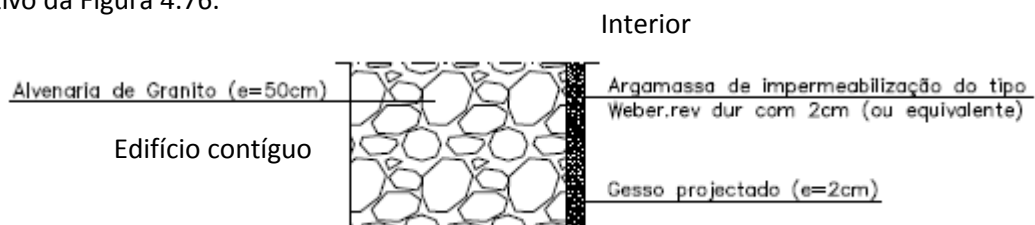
Pormenor construtivo da parede Pi2 [17]
